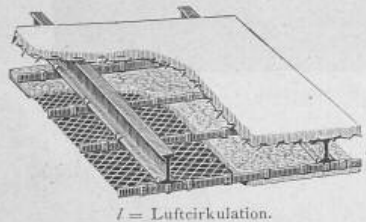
Aufgehängte Mörteldecke auf Streckmetall u. Betonplatten in Streckmetall.
